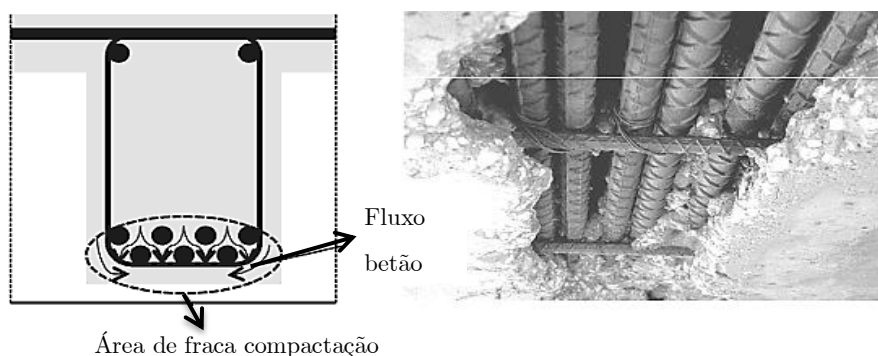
Excesso de armadura provocando fraco posicionamento
